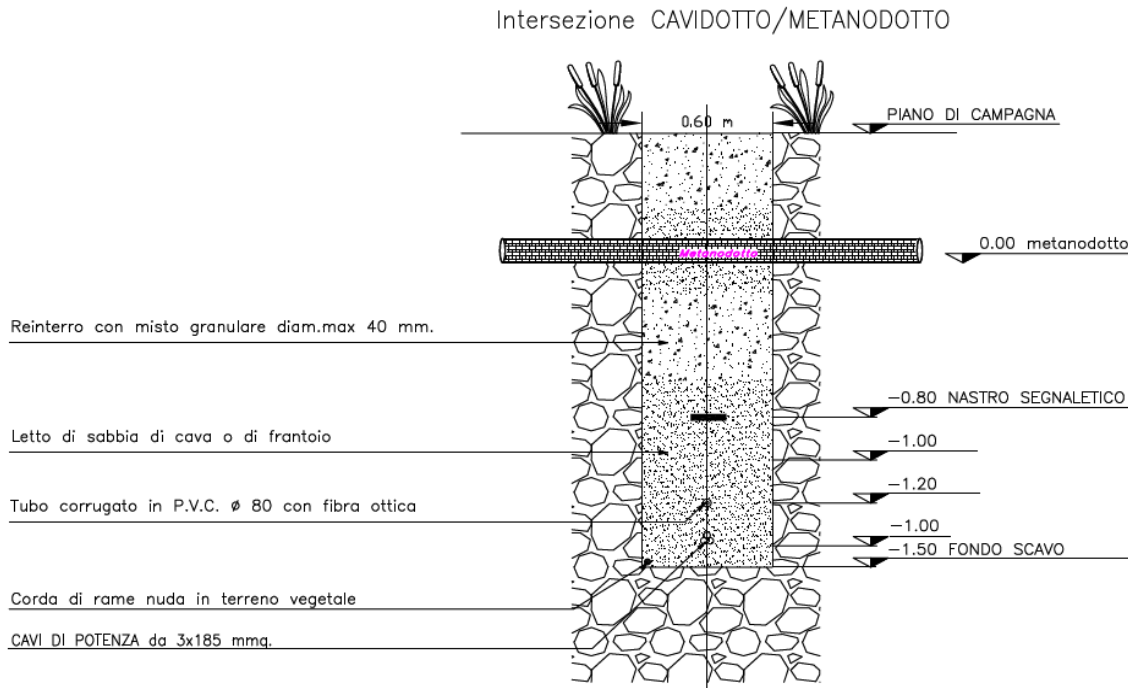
Tipico Cavidotto- intersezione con metanodotto
